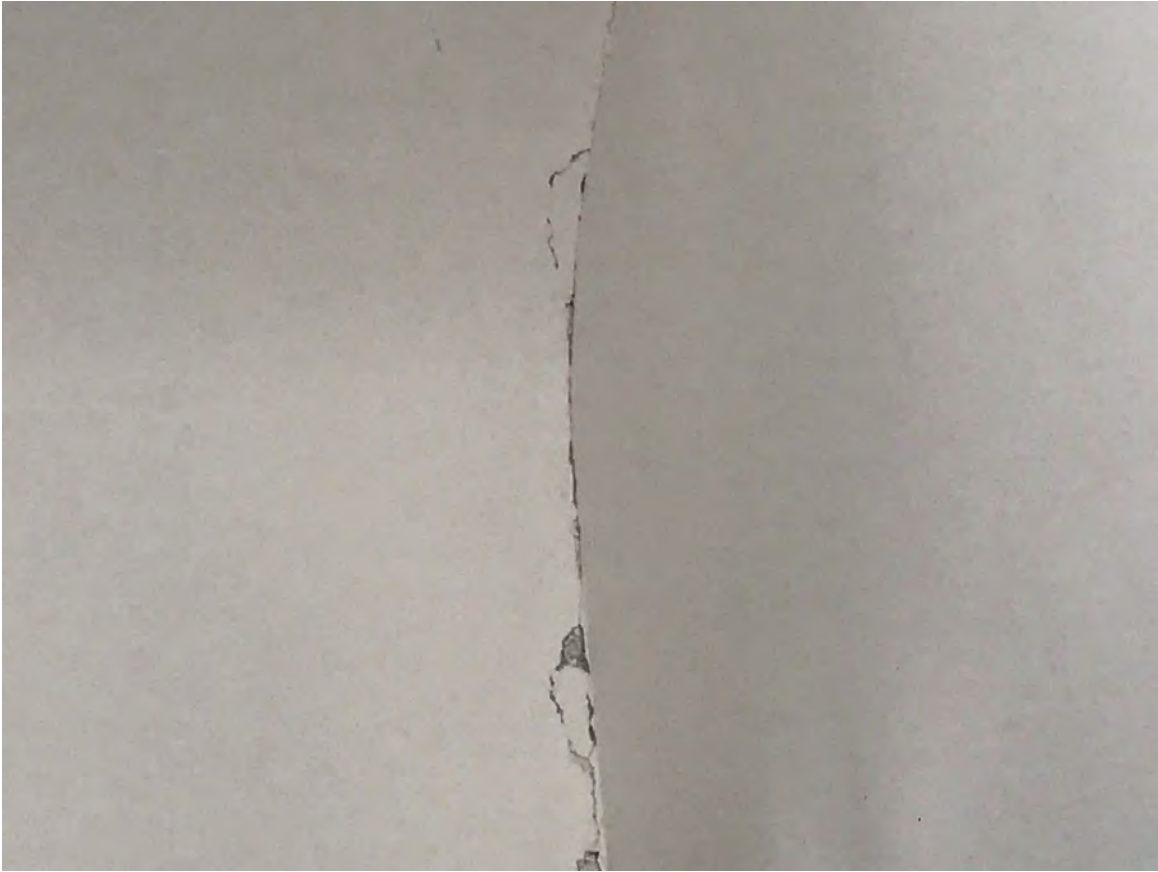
distacco del solaio dalla muratura portante (cono ottico 1)
